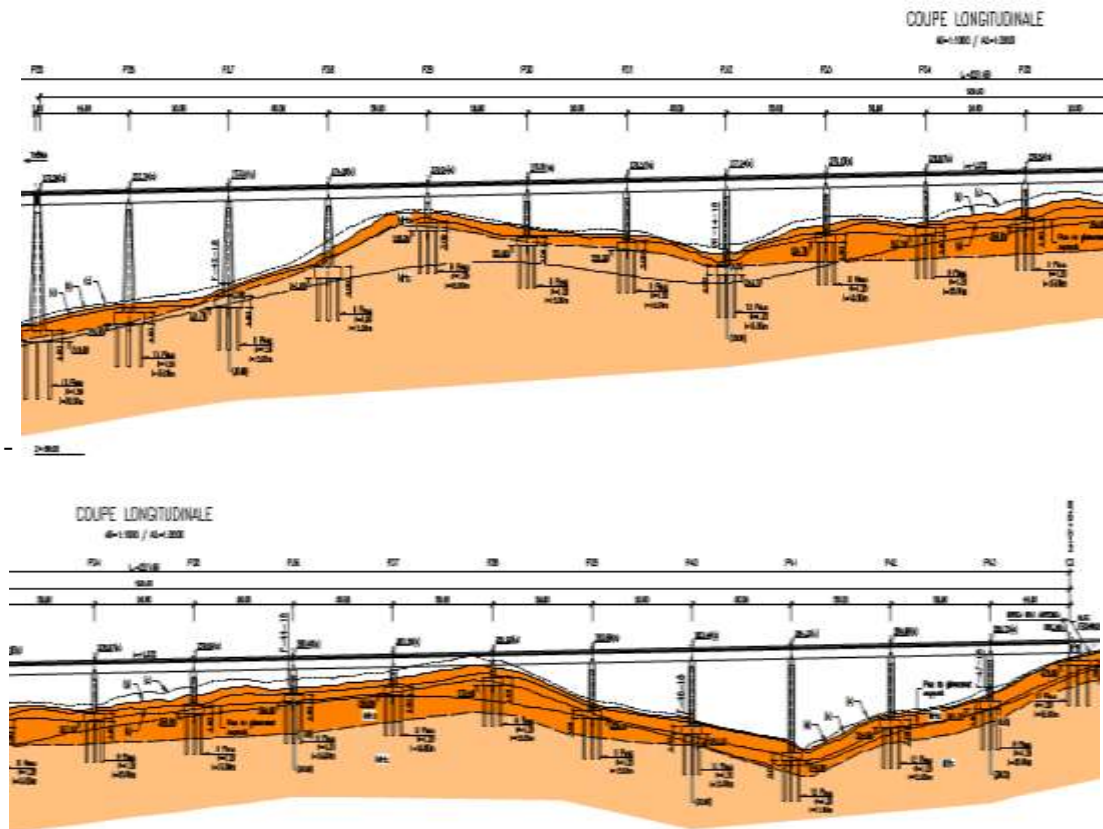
Des coupes longitudinales d'Élévation de l'ouvrage d'art 22
